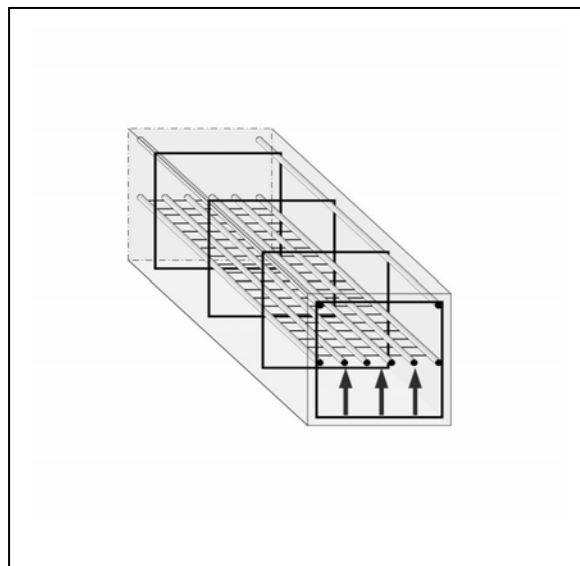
Lage der Bewehrung nach dem Betonierprozess
